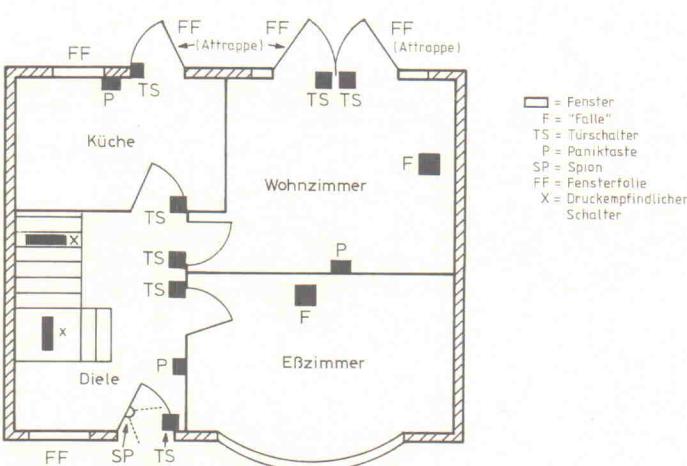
Grundriß des gleichen Hauses mit hochwertigem Umgebungs- und Punktschutz sowie Paniktasten.
